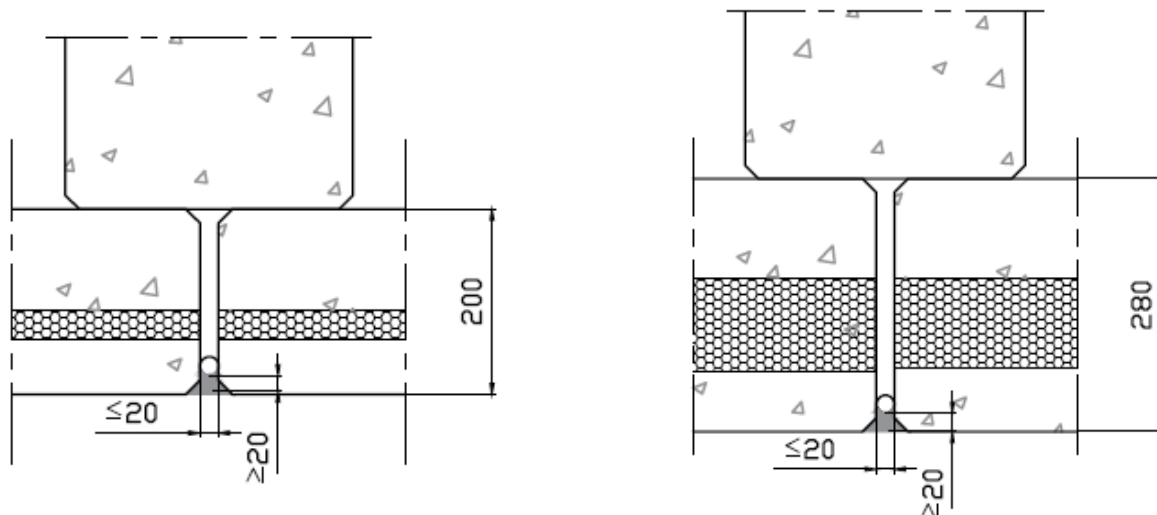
panneaux sandwichs en béton (à gauche, 20 cm, à droite, 28 cm) + colonne
